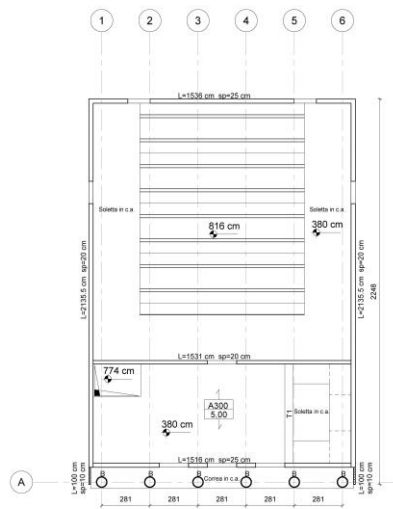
Edificio C (Auditorium): Vista speculare impalcato primo piano
